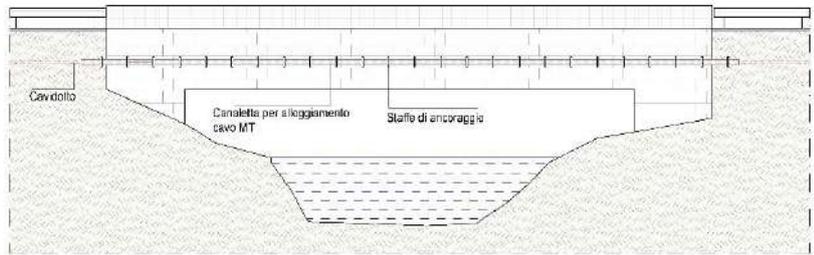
Dettaglio attraversamento ponte stradale – Pianta e Prospetto
